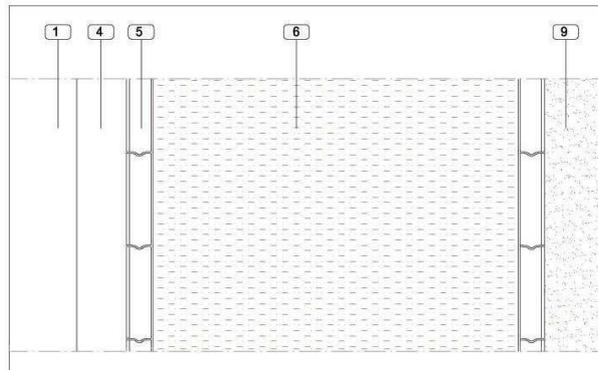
pianta percorso ciclabile con pavimentazione in misto stabilizzato cementato
